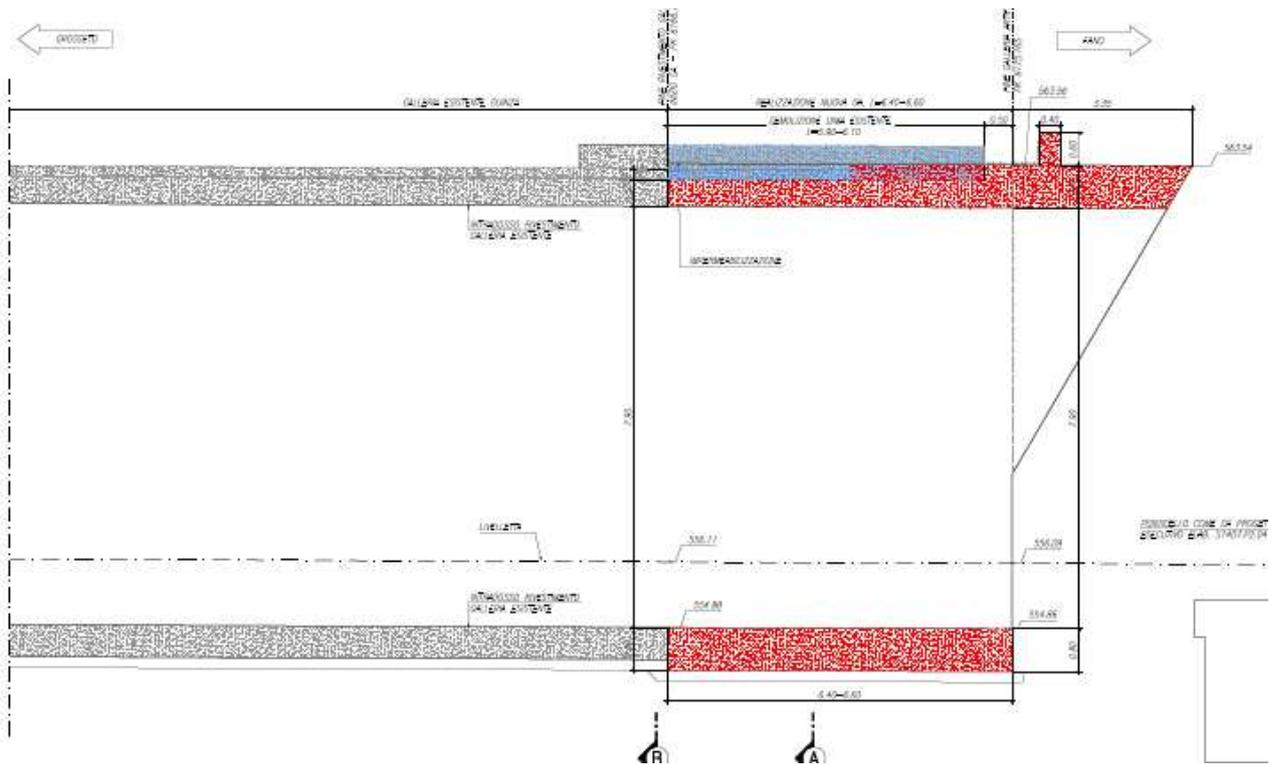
Galleria Guinza - Imbocco lato Marche - Profilo galleria artificiale
